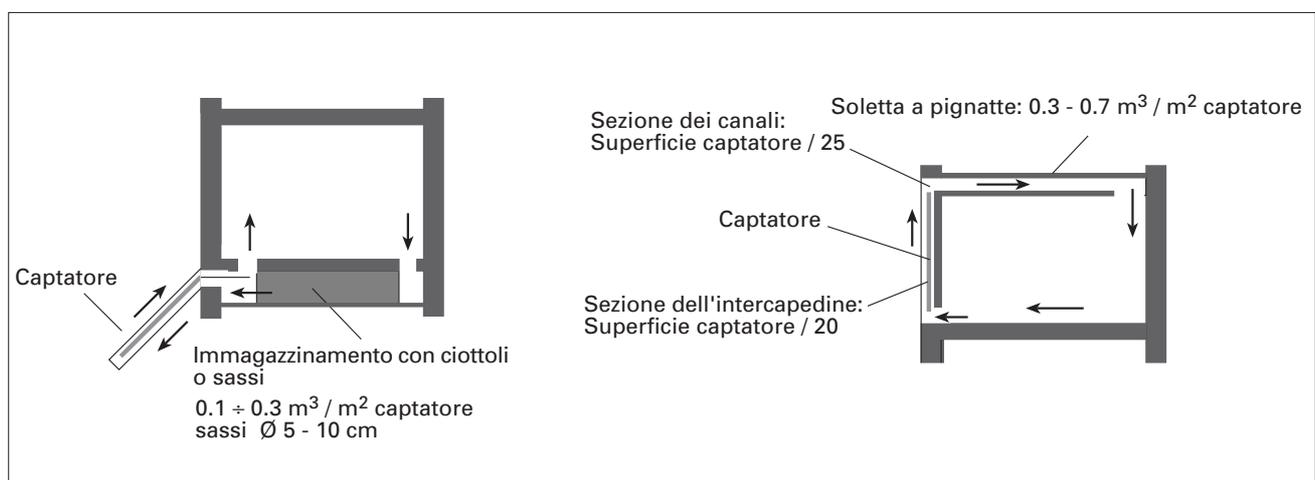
immagazzinamento con letto di ciottoli o soletta a pignatte con collettori ad aria in facciata. Dimensionamento di base [4, 7, 13, 17].
